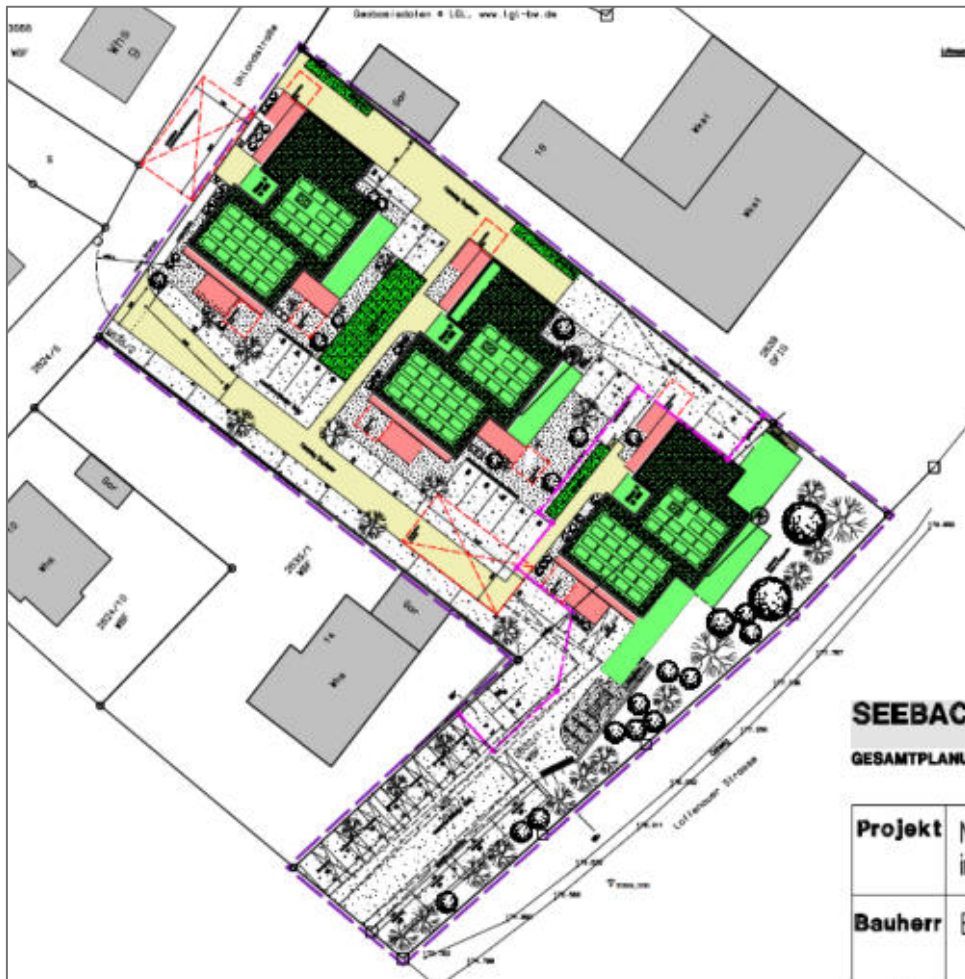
Lageplan Entwurfsplanung des Vorhabens (Seebacher Architekturconsult, Stand: 17.05.2024)
